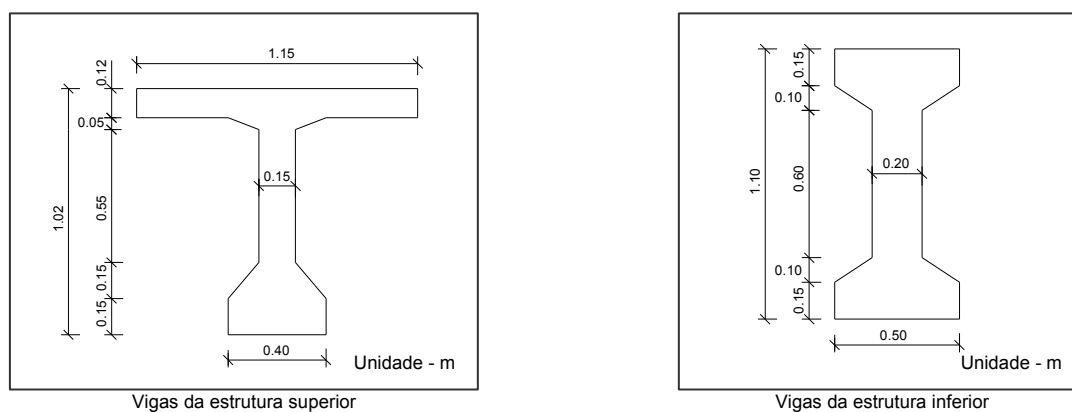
Secção das vigas do viaduto do Terminal de Petroleiros.
